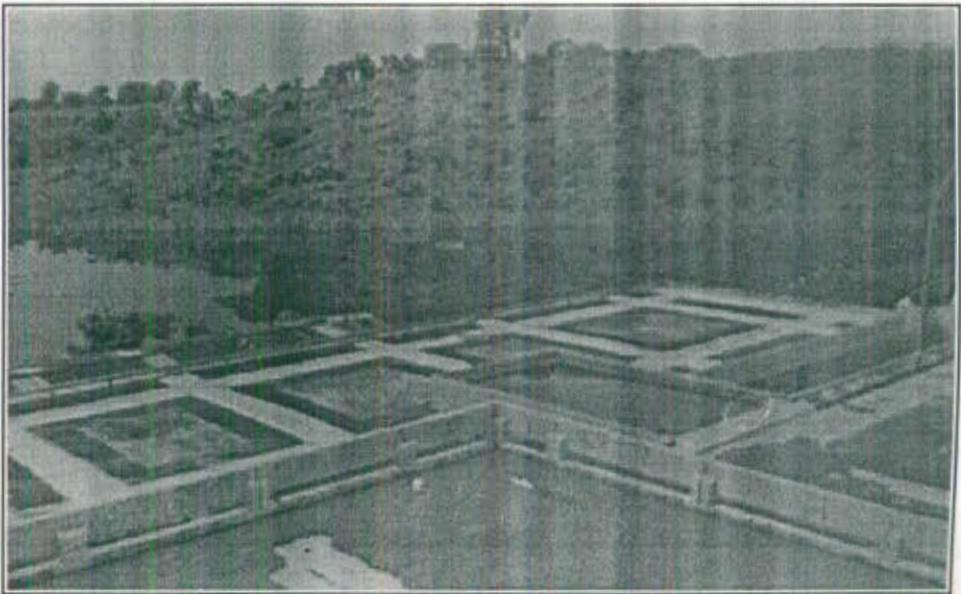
VISTA DE LOSA DE CUBIERTA DE LAB. DE CRUSTACEOS, ICTIOLOGIA Y BIOENSAYOS (LAB. DE ACUIC.) DE F.I.M.C.M.
